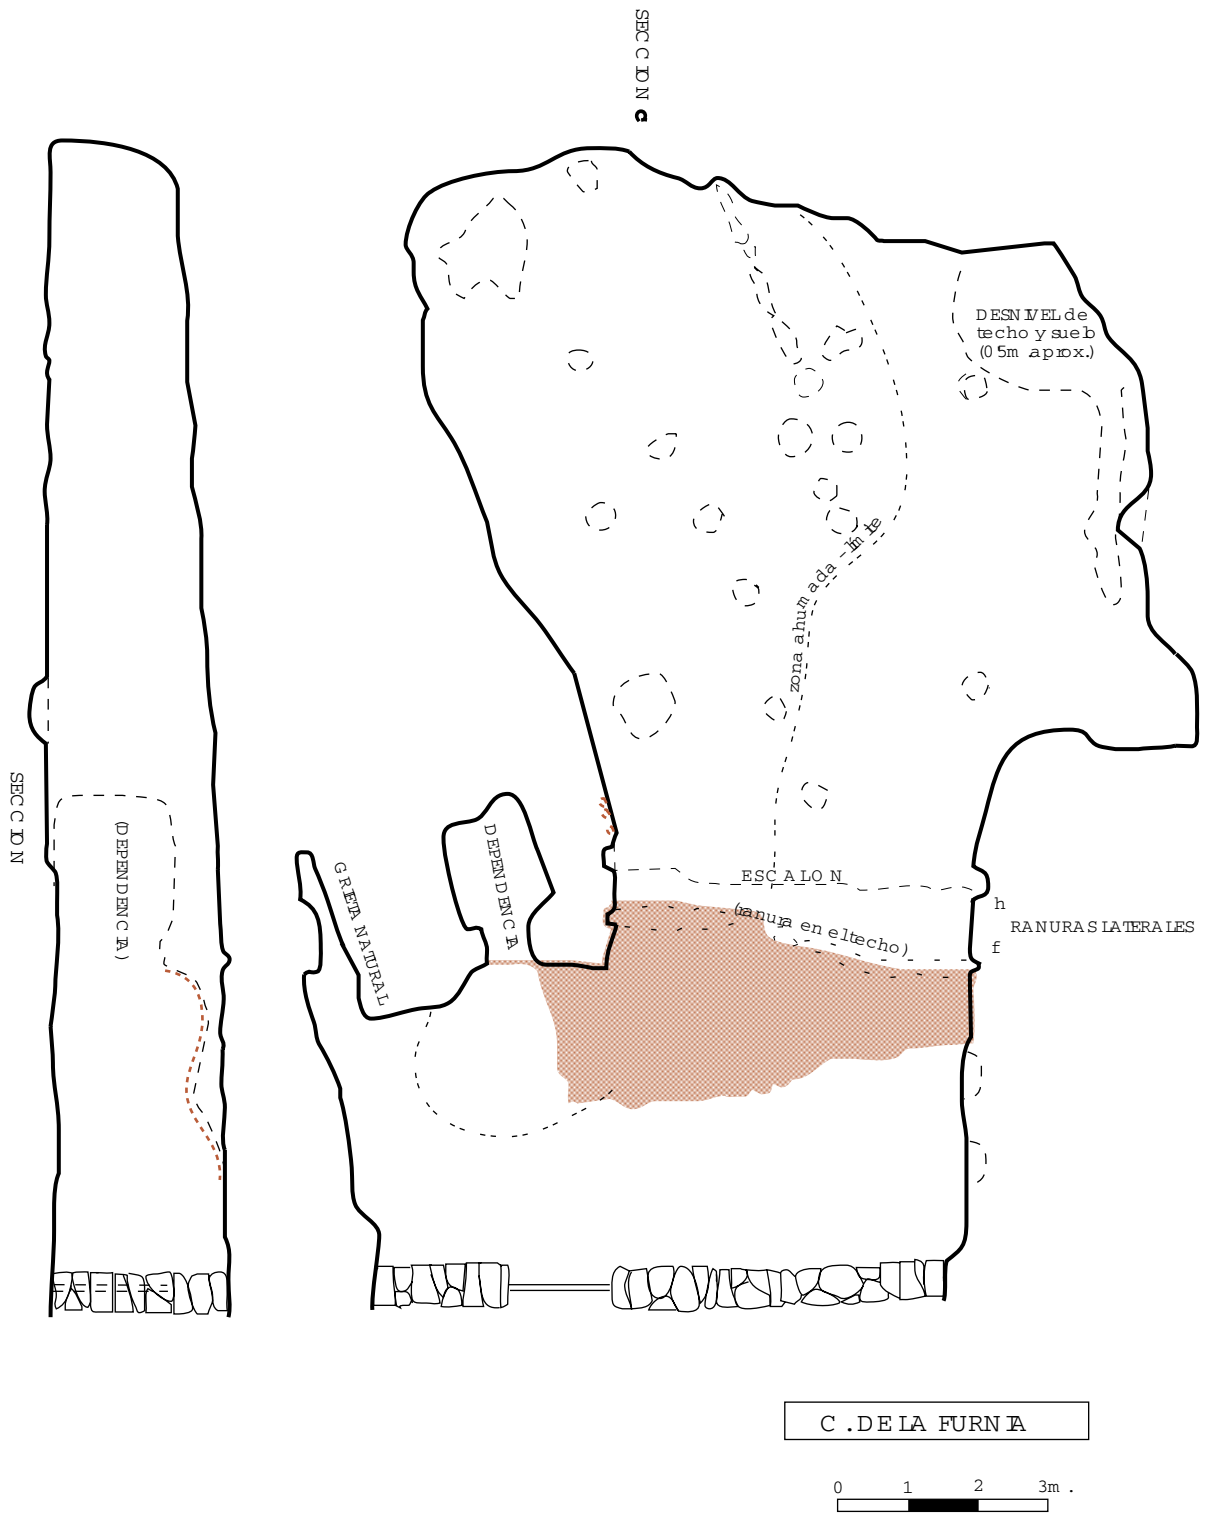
CUEVA DE LA FURNIA: PLANTA, SECCION Y ZONAS CON PINTURA. Se refiere a la planta de la cueva hasta el cenaminto actual con muro de piedra; con \times se indican las zonas que presentan pintura de este color. En la sección se ha proyectado la situación de la pequeña dependencia.
